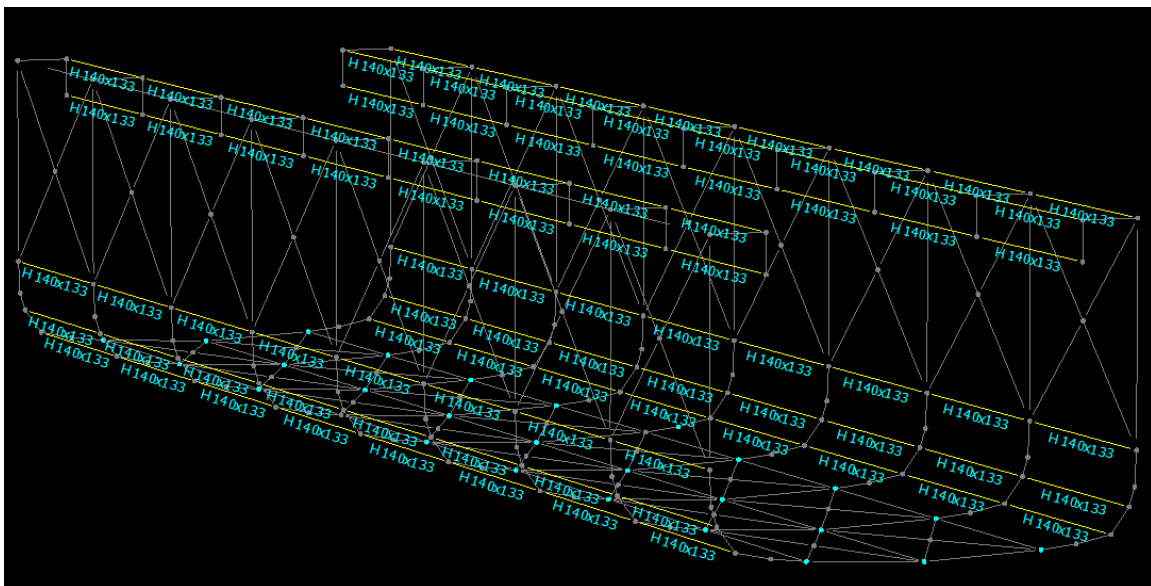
Reforzamiento longitudinal de los lados de la estructura de protección.
